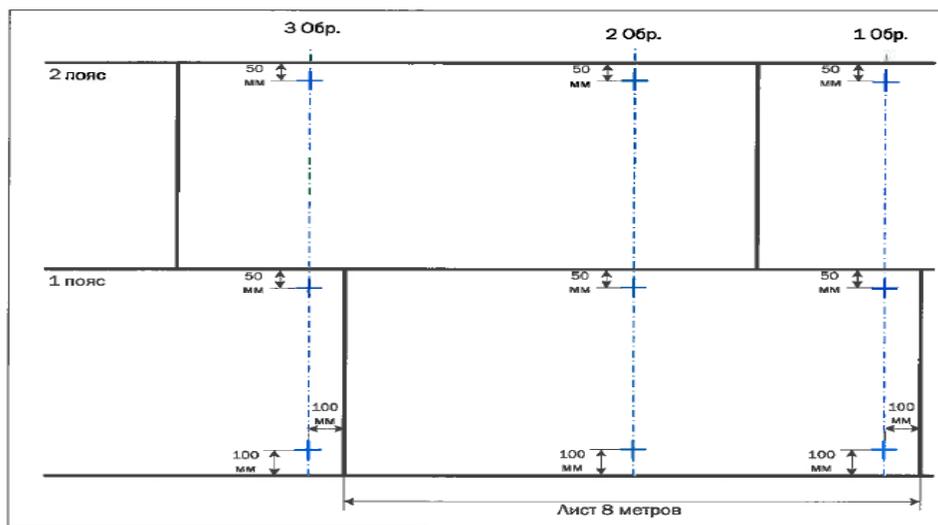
Разметка образующих резервуара метками [21].
